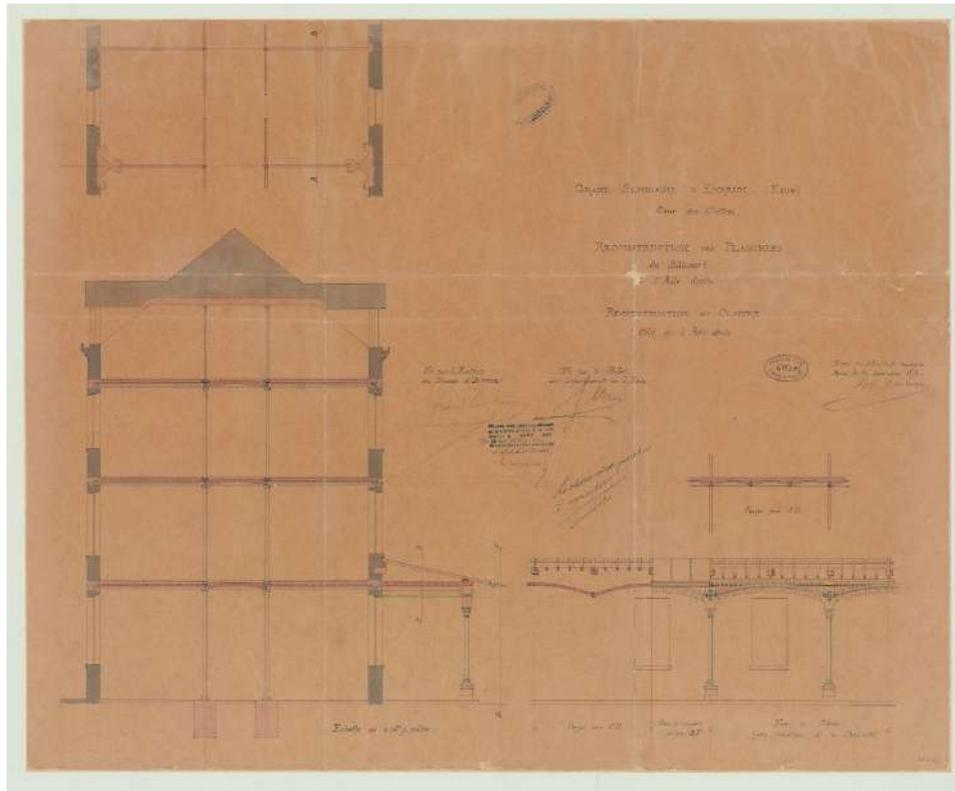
Reconstruction des planchers. ADE 6 PL 274.
